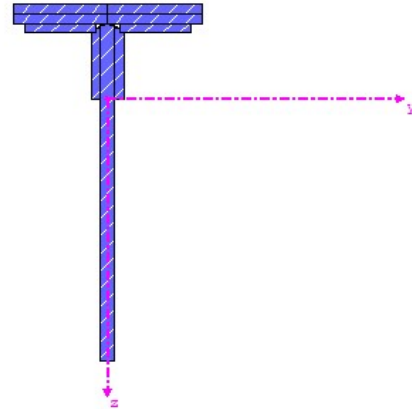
Renderovaný model průřezu – horní pás příhrad č. 1, 2, 9 a 10
